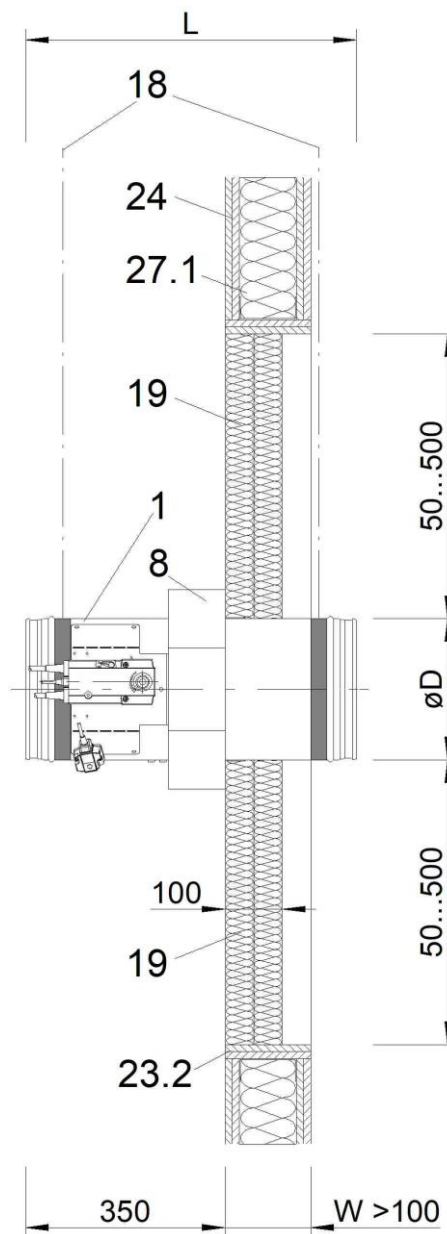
montaggio nella parete con struttura di supporto metallico (spessore parete > 100 mm)
